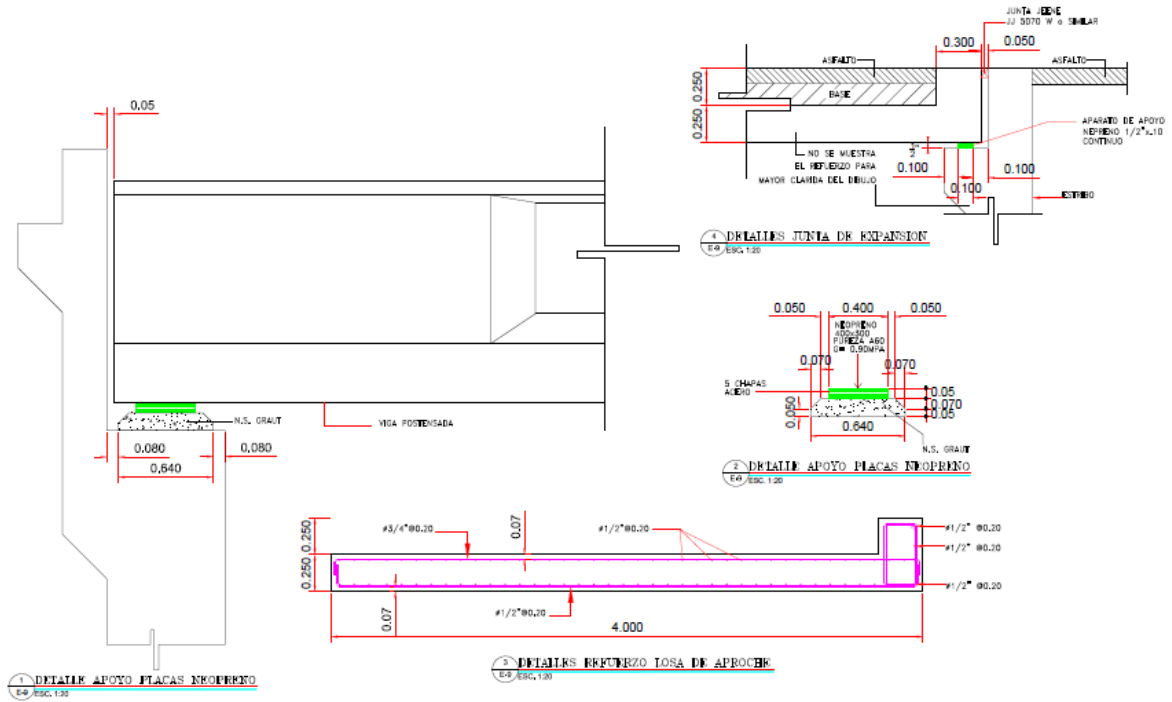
Plano detalles típicos de estructura de puentes de hormigón armado
